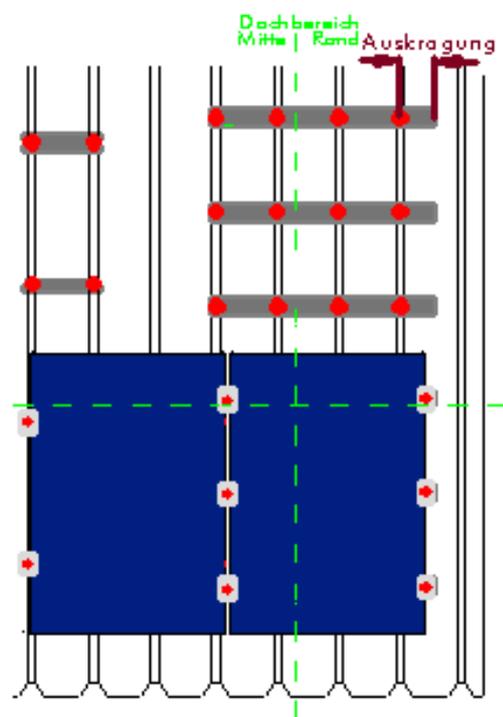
Prinzipskizzen zur Befestigung der C-Schienen auf Trapezblech – Befestigungsvarianten
